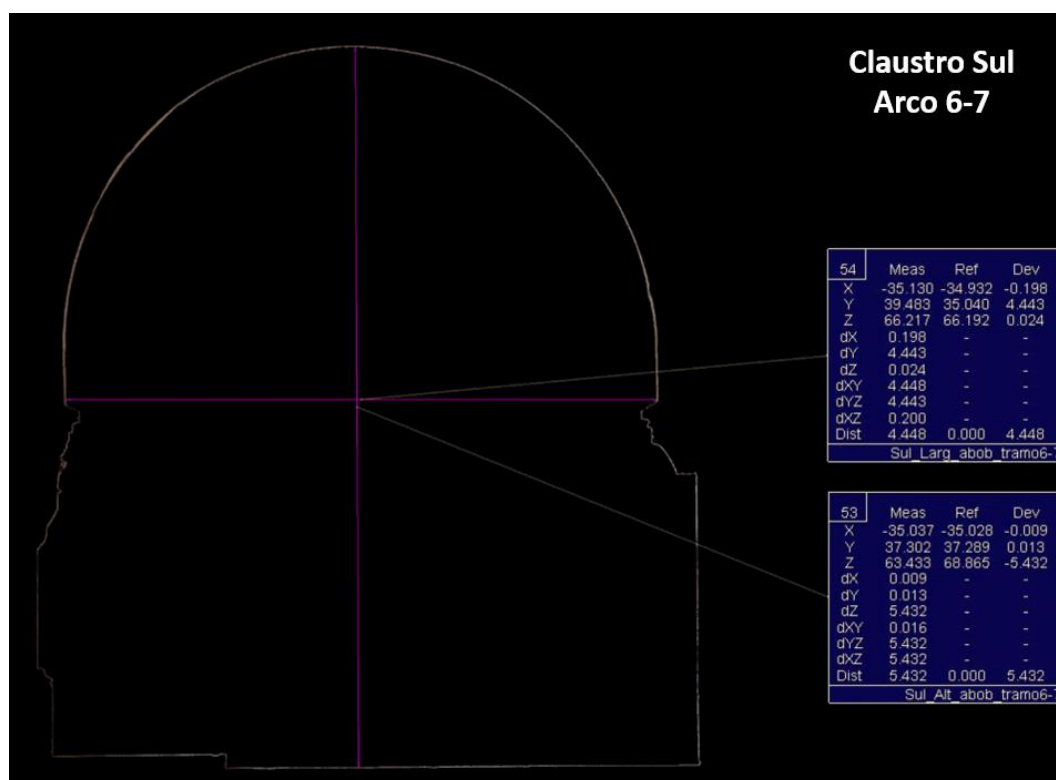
Corte transversal do Arco 6-7 do claustro Sul de D. Dinis.
